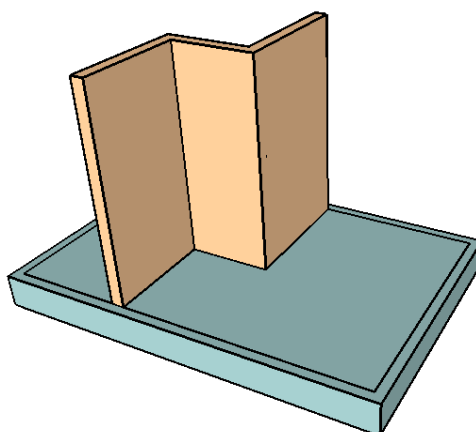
Panos de Alvenaria sobre Laje maciça.
